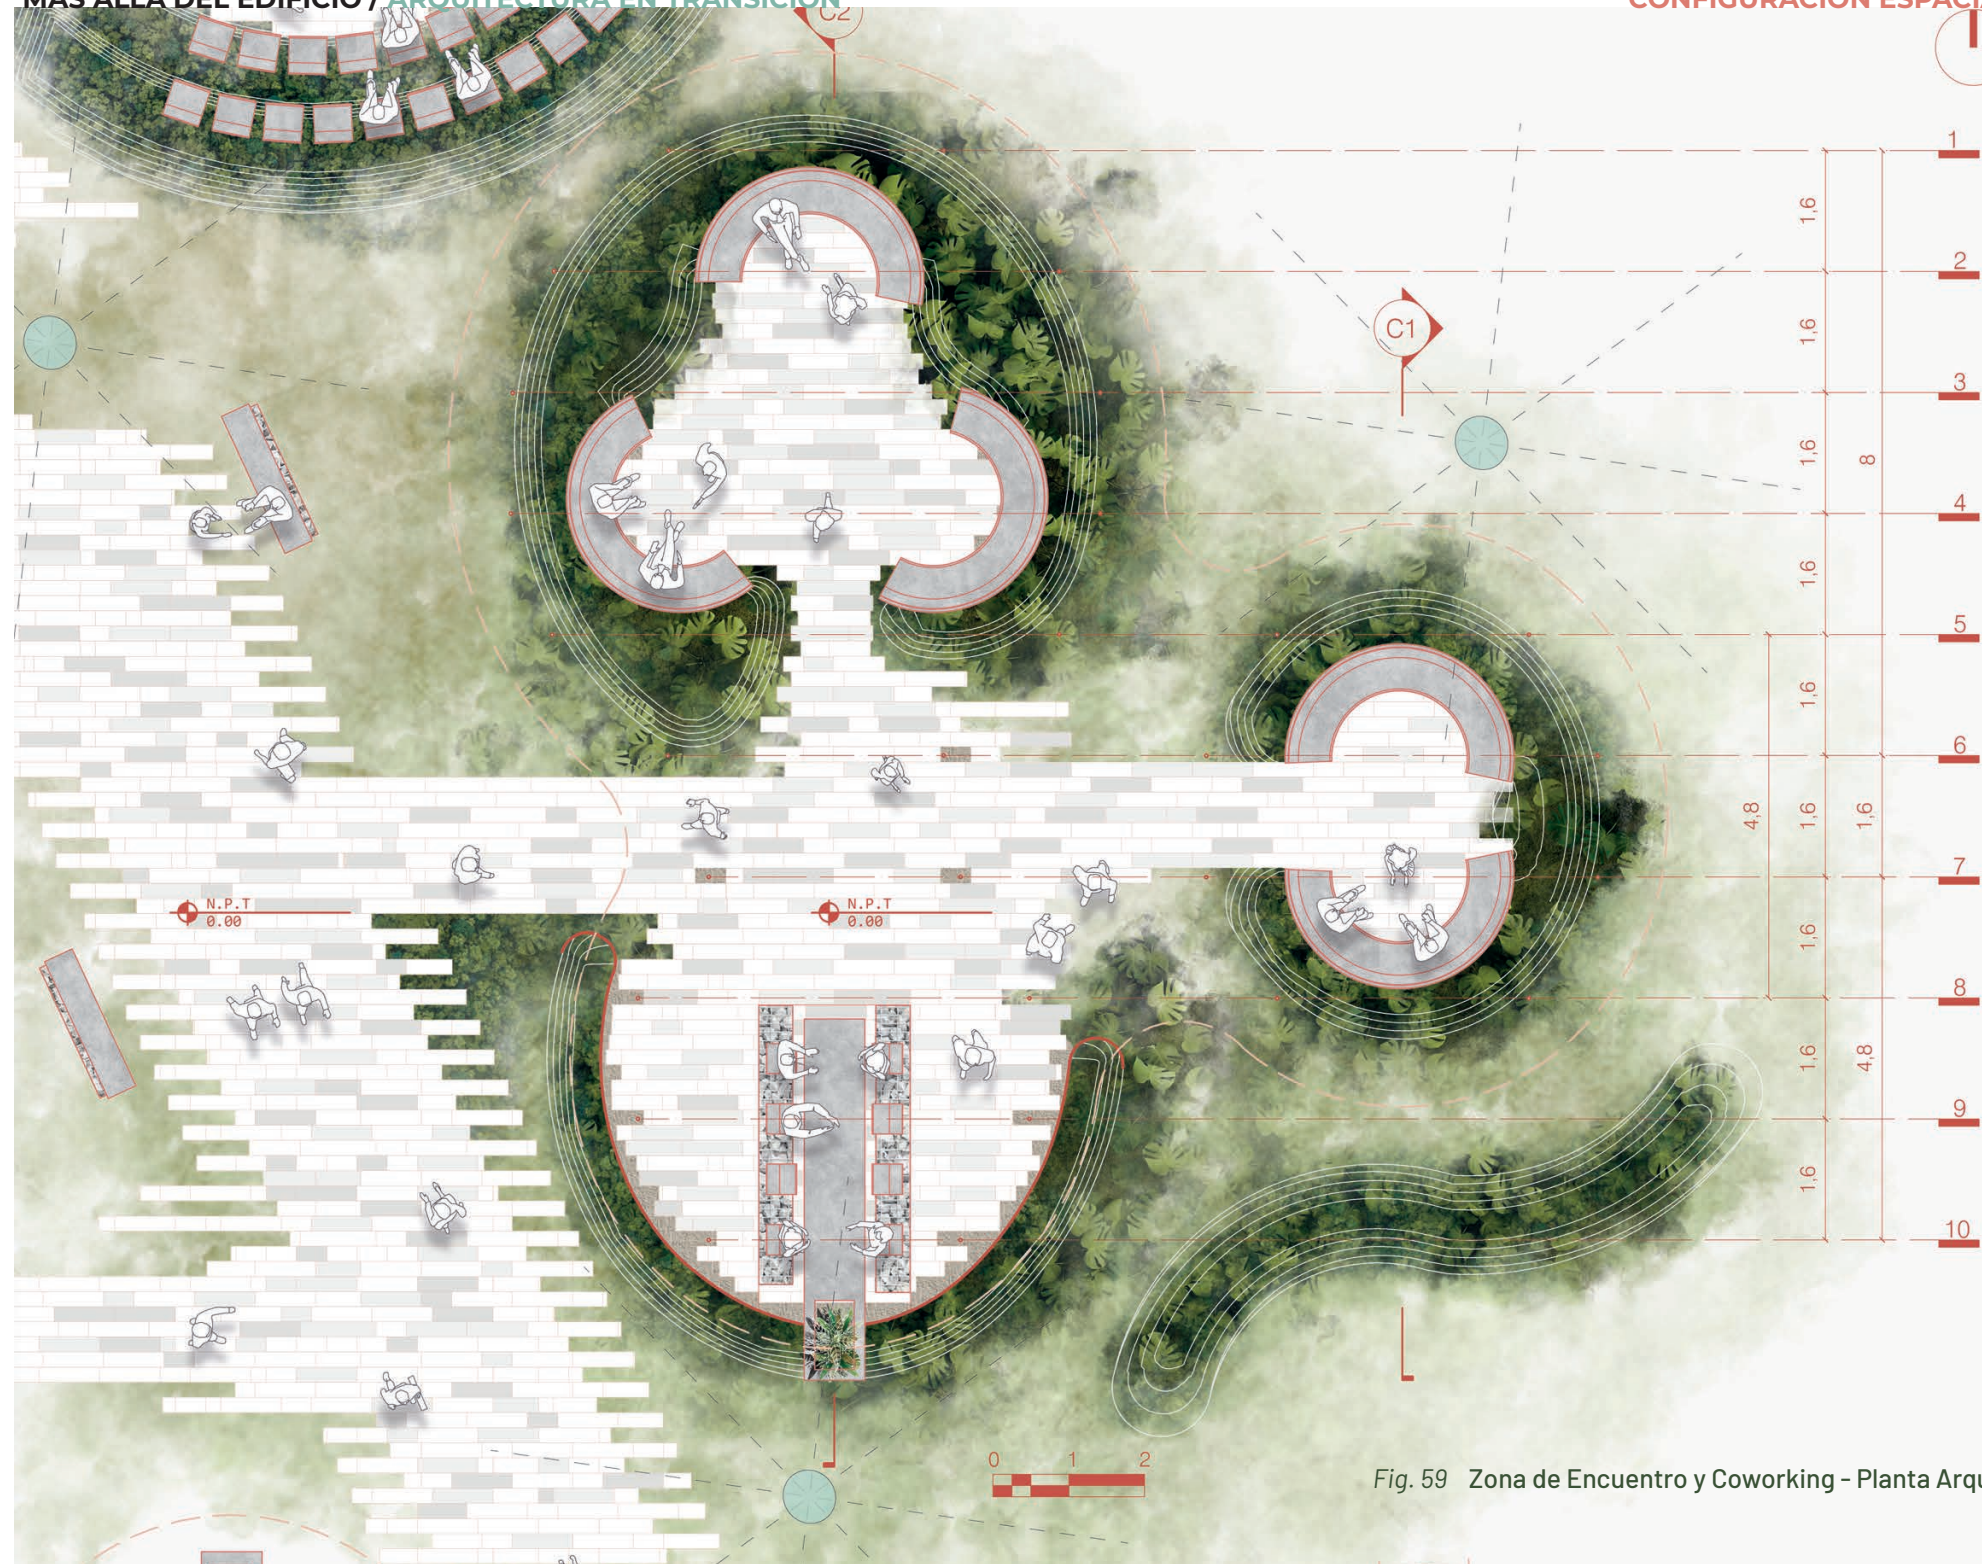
Zona de Encuentro y Coworking - Planta Arquitectonica
